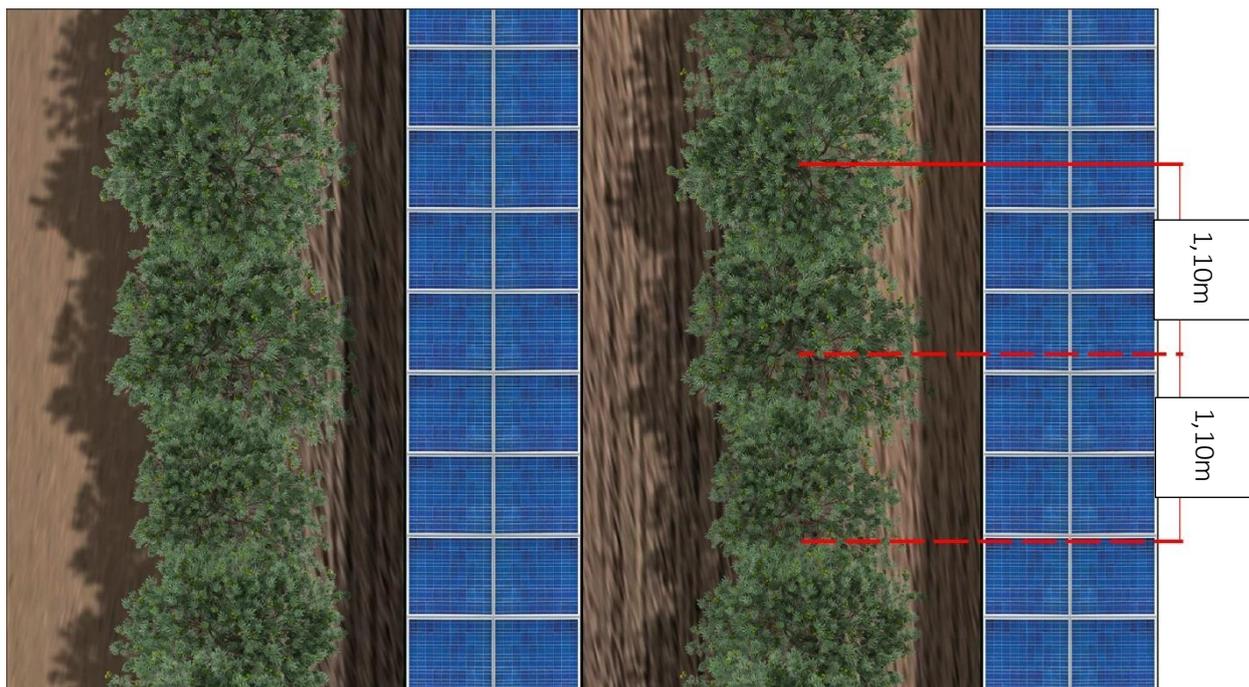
Tipologico – Vista Planimetrica dell’impianto Olivicolo.
